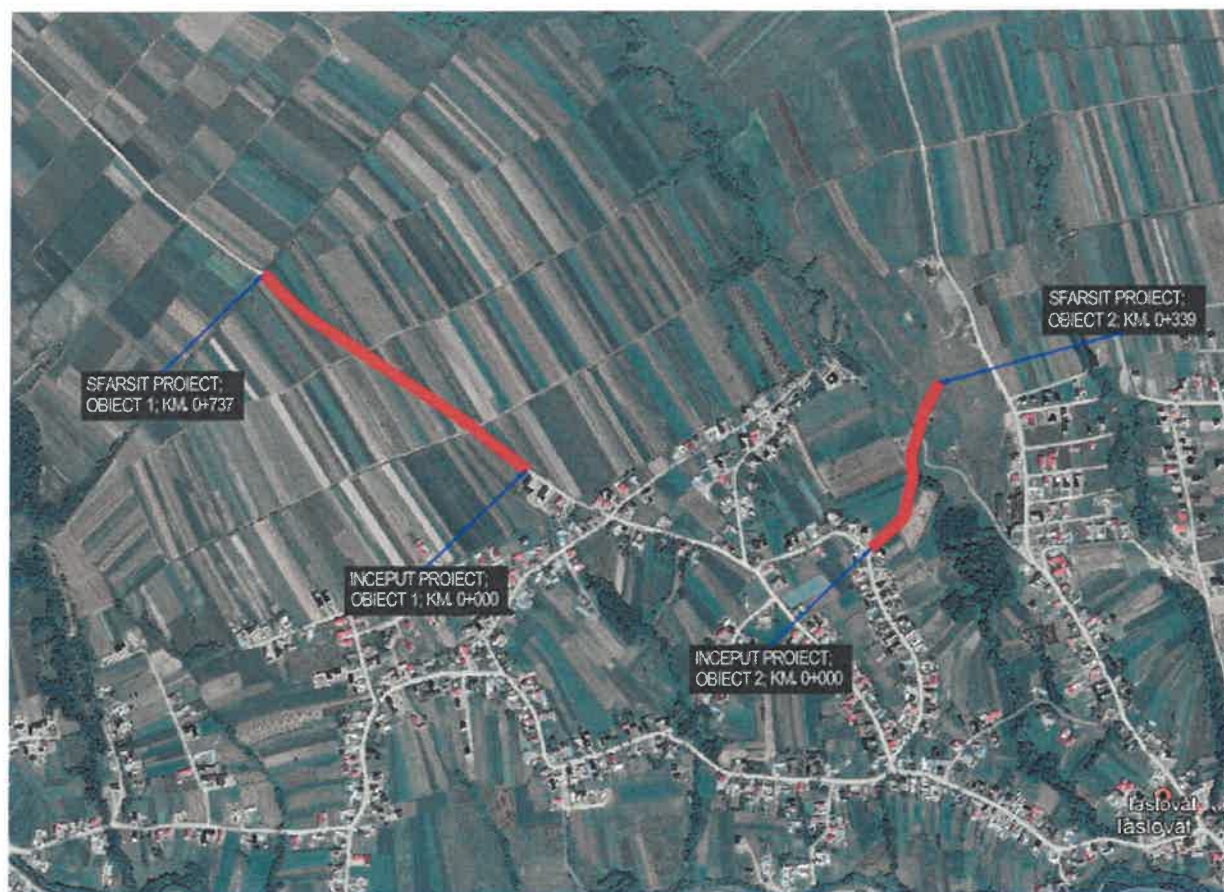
Plan de amplasare în zonă – OBIECT 1 si OBIECT 2
